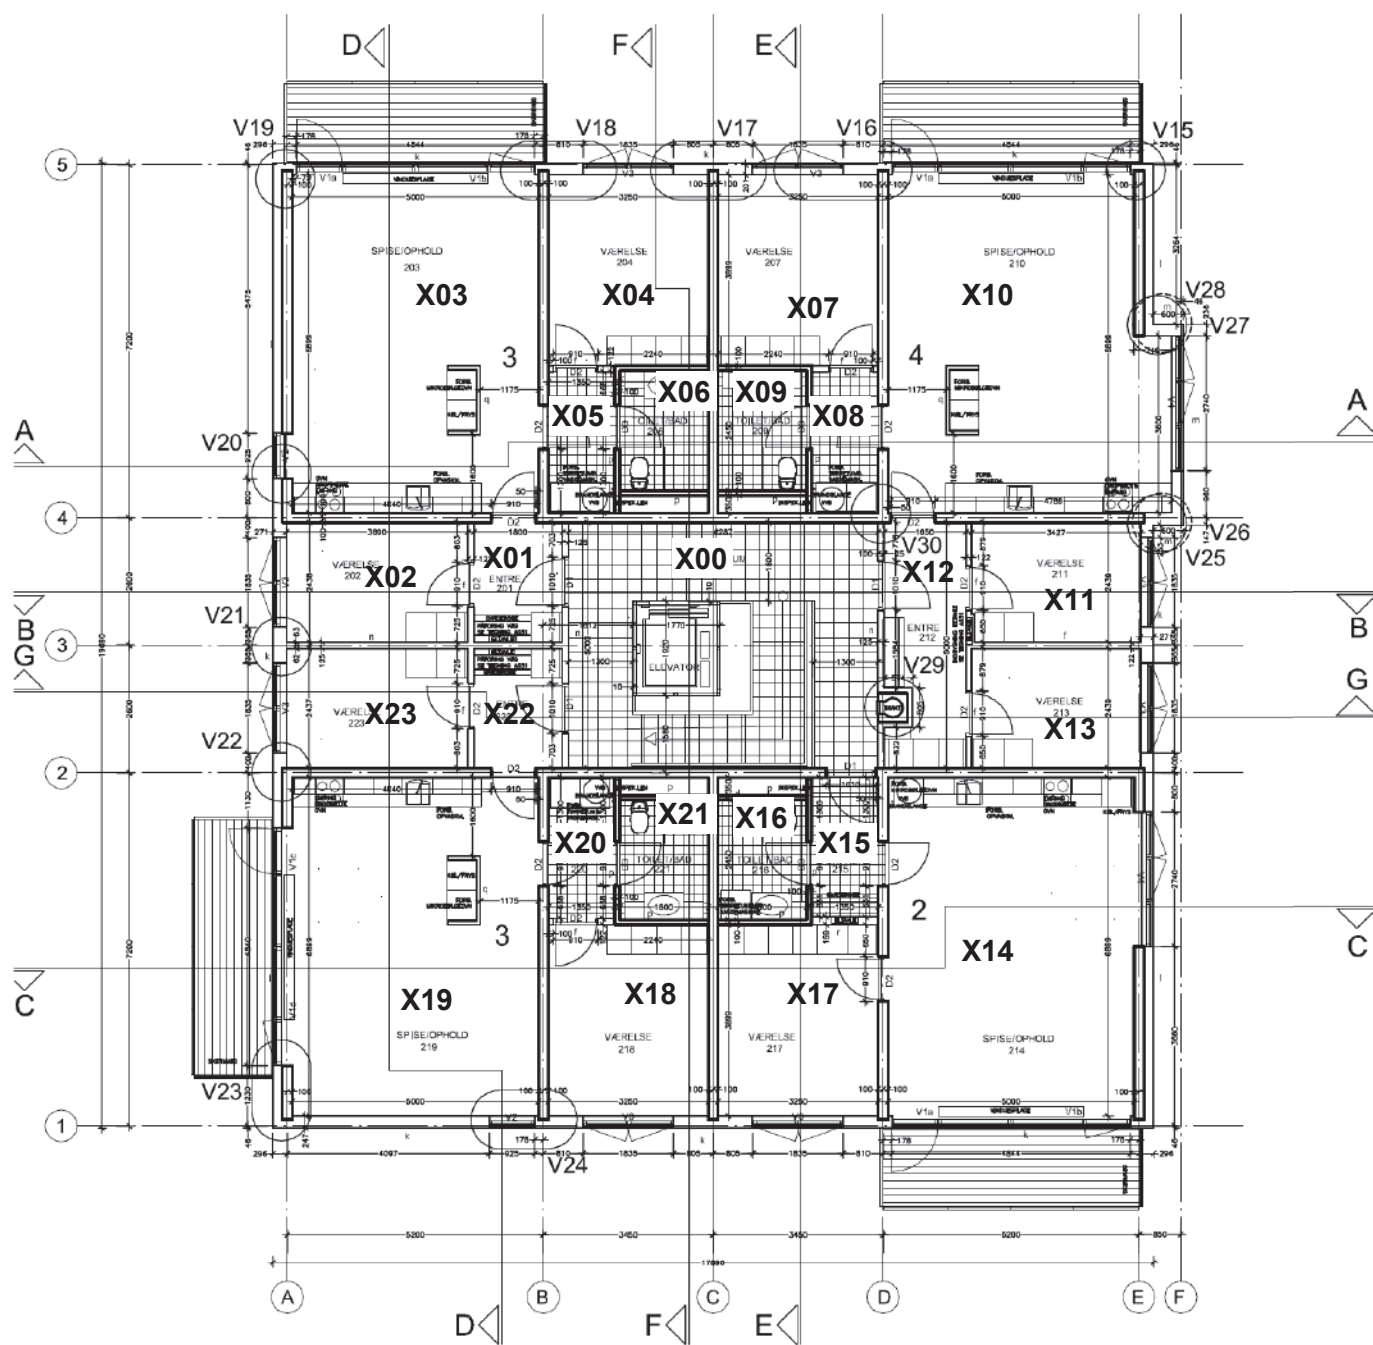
Situationsplan Tuapannguit 1, 3, 5, 7, 9, 11A, 11B (Blok 7-1). Målinger foretaget i Tuapannguit 3 (B-3770).
